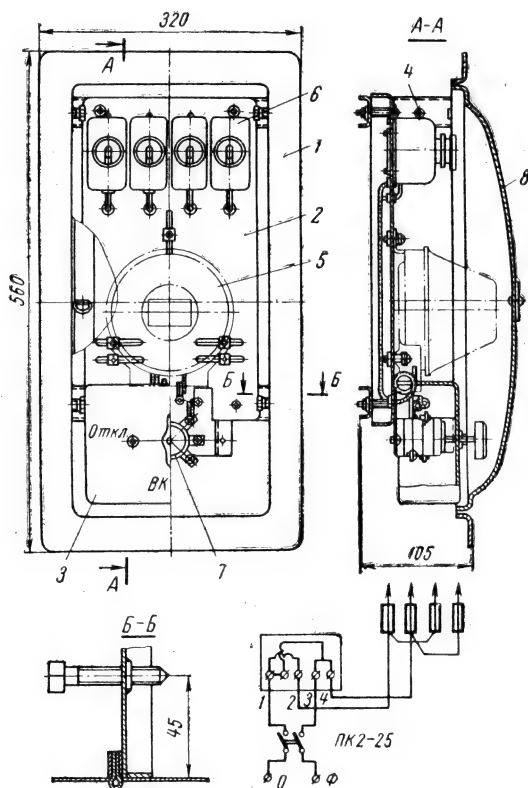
Щиток осветительный квартирный для скрытой установки типа ЩК-16.
